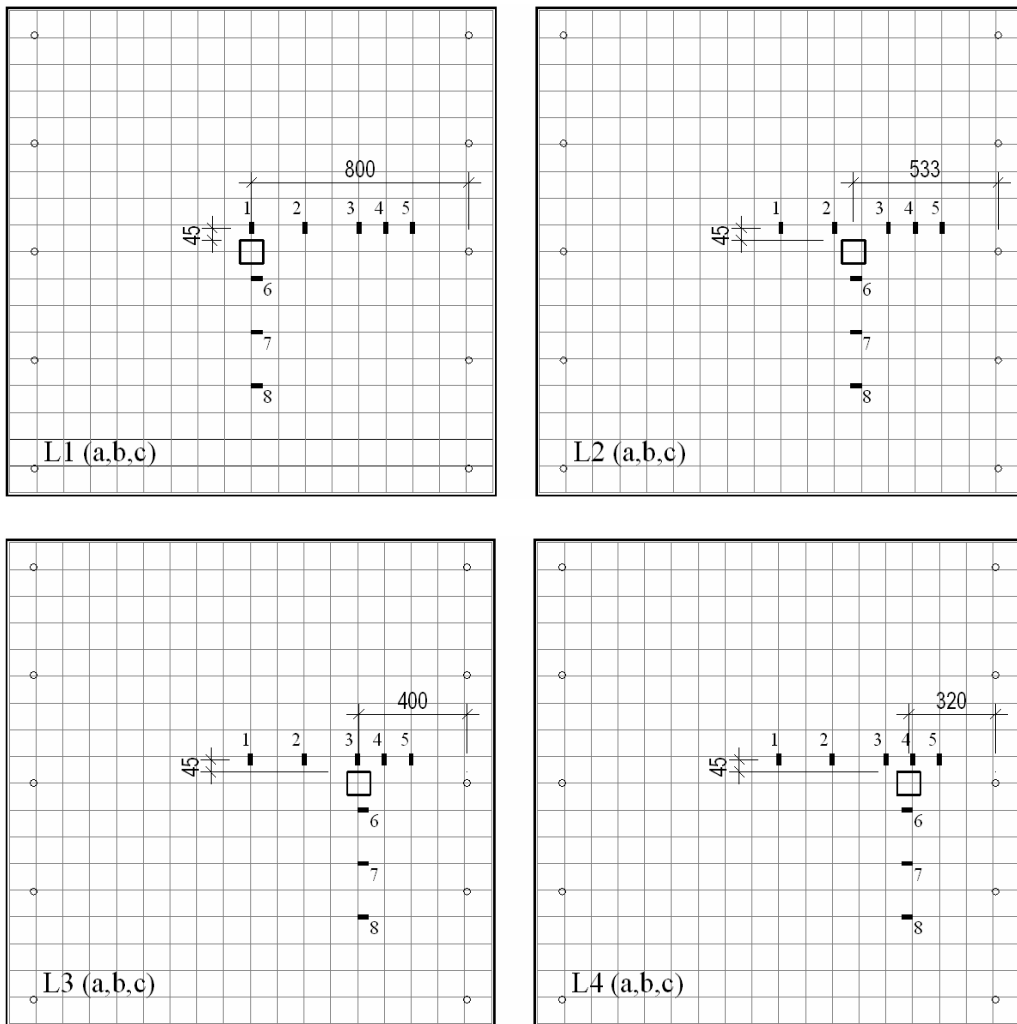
Posicionamento dos extensômetros nas armaduras de flexão
